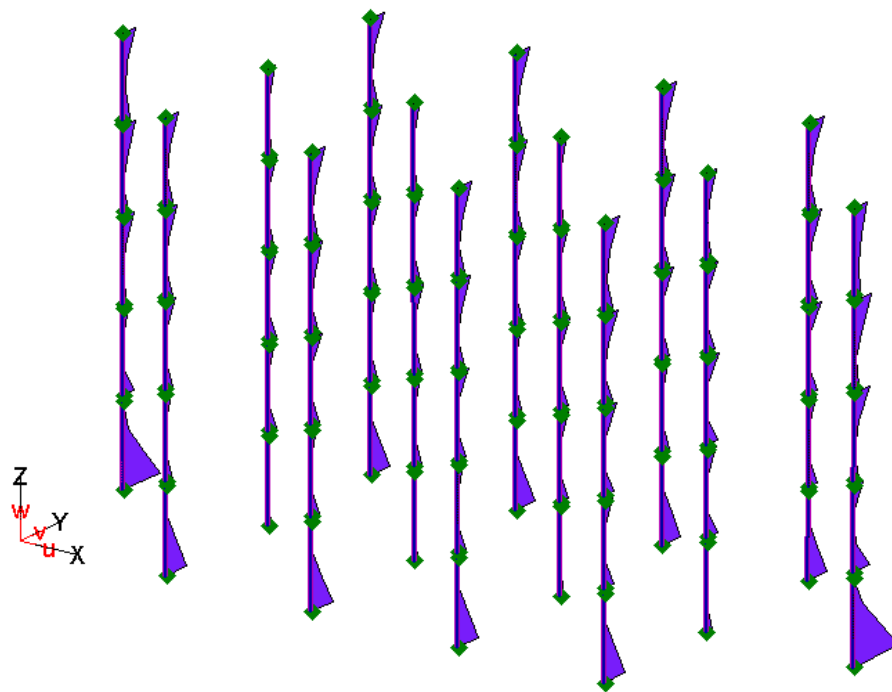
Значения эпюр арматуры в некоторых колоннах (Схема с использованием оболочечных элементов стен по нормам СП).
